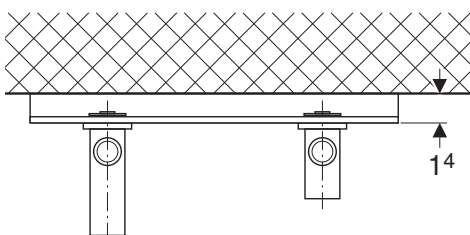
Dimensiones para montaje visto con placa de fijación Geberit recta
